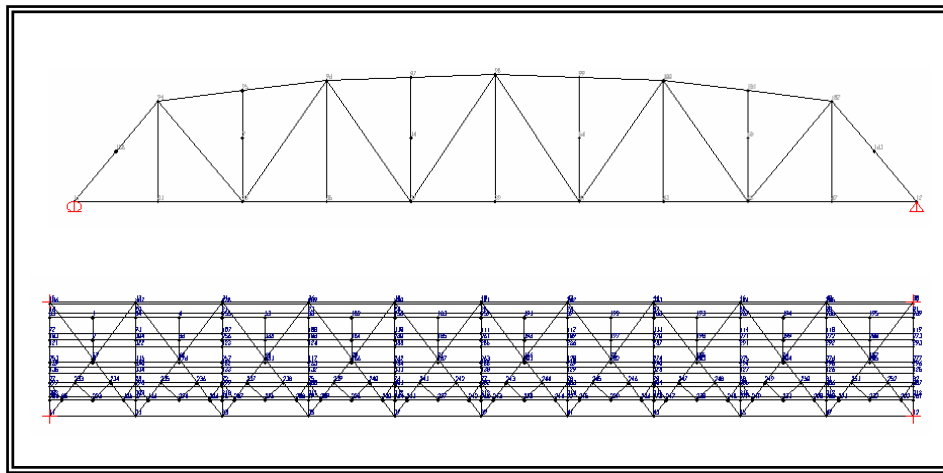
Vista lateral (arriba) y en planta (abajo) del puente obtenido del modelo estructural realizado en SAP2000n
